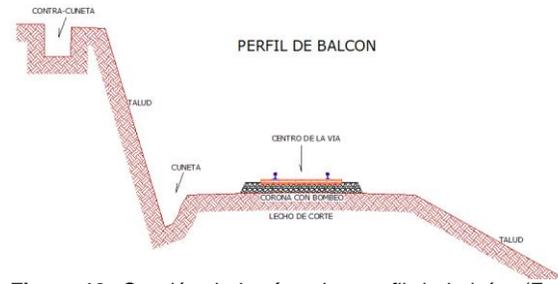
Sección de la vía sobre perfil de balcón. (Fuente: Autor)
